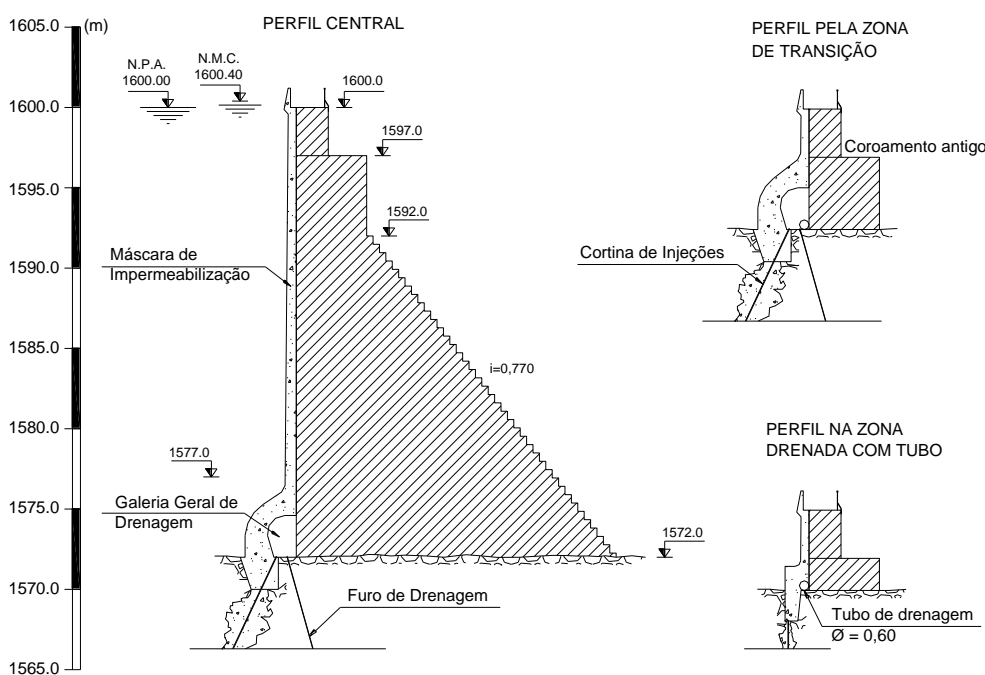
Perfil esquemático das obras de reabilitação e de alteamento realizadas entre 1964 e 1967
